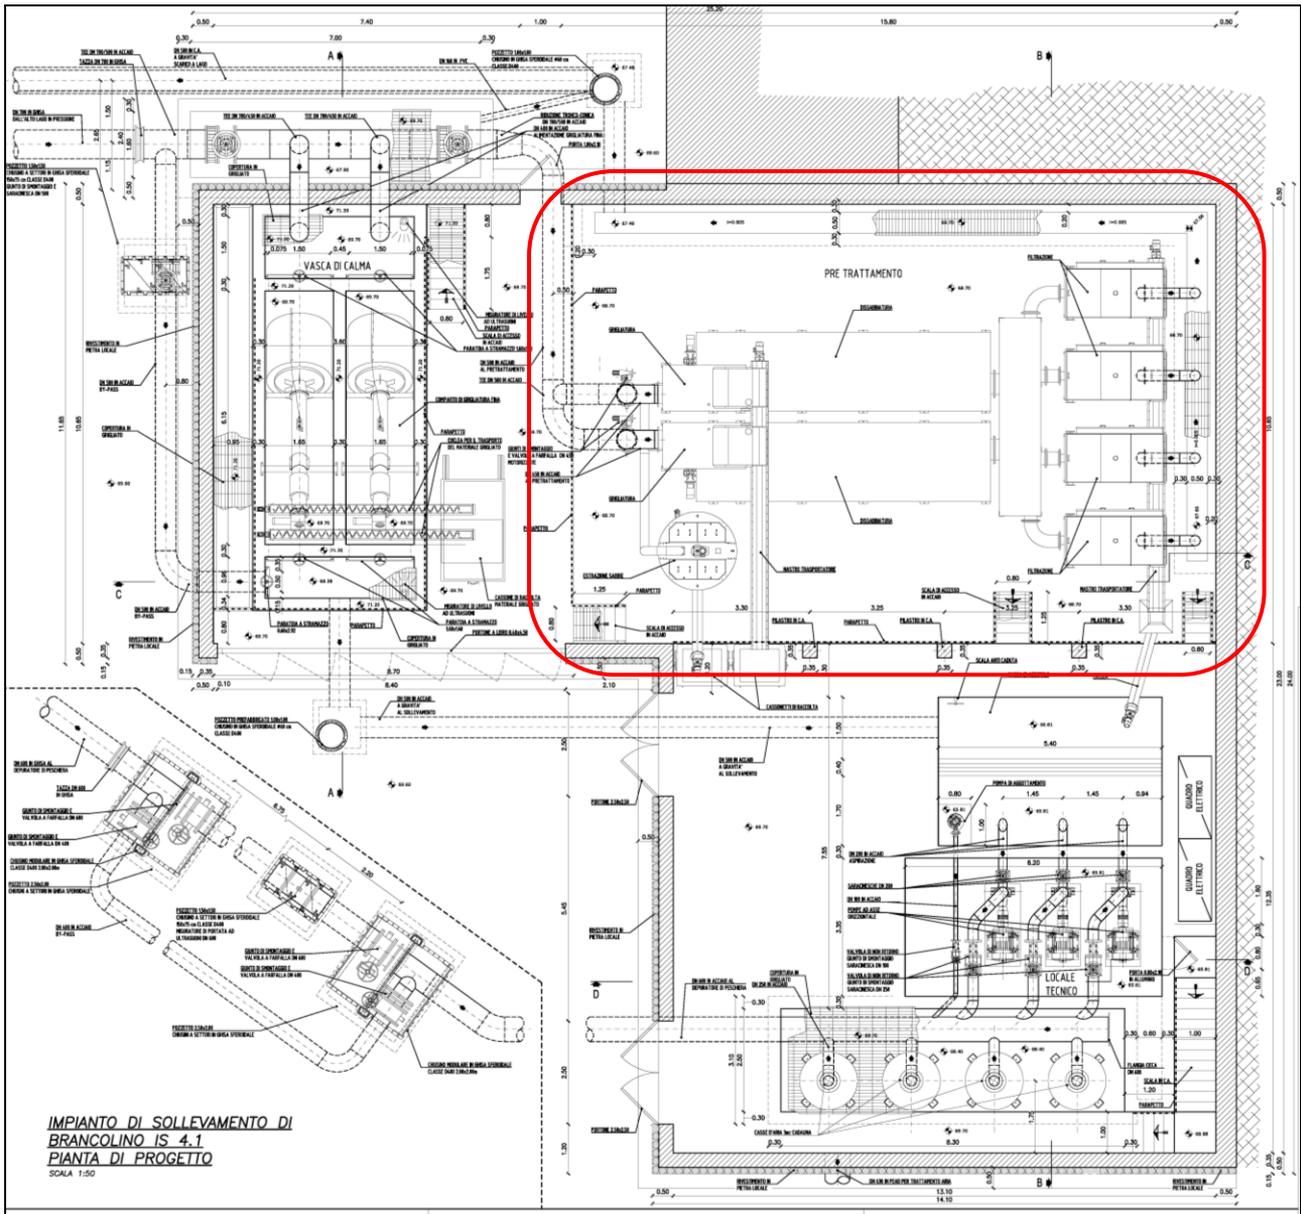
Estratto planimetrico dell'impianto di Brancolino di Torri d/B oggetto di installazione di un sistema di trattamento avanzato delle acque di sfioro.
